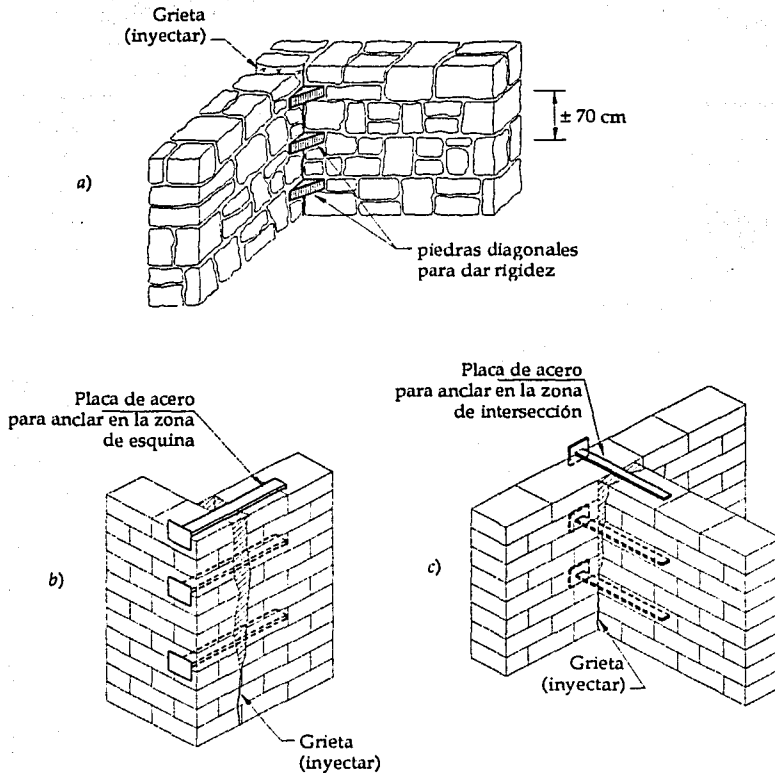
Reforzamiento en esquinas e intersección de muros; a) reforzamiento de la esquina de un muro de mampostería de piedra con "piedras de rigidez"; b) anclaje en esquina con placas de acero; c) anclaje en intersección con placas de acero (Tomazevic y Anicic, 1989).
